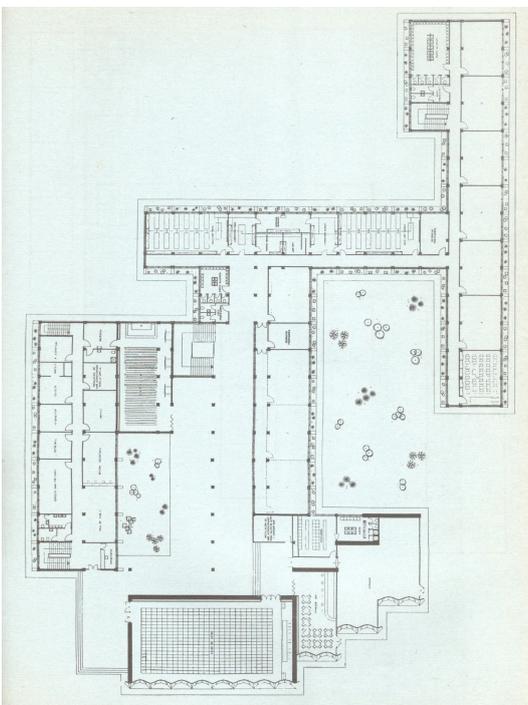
Planta baja del Instituto Sorolla. Fuente: COACV
